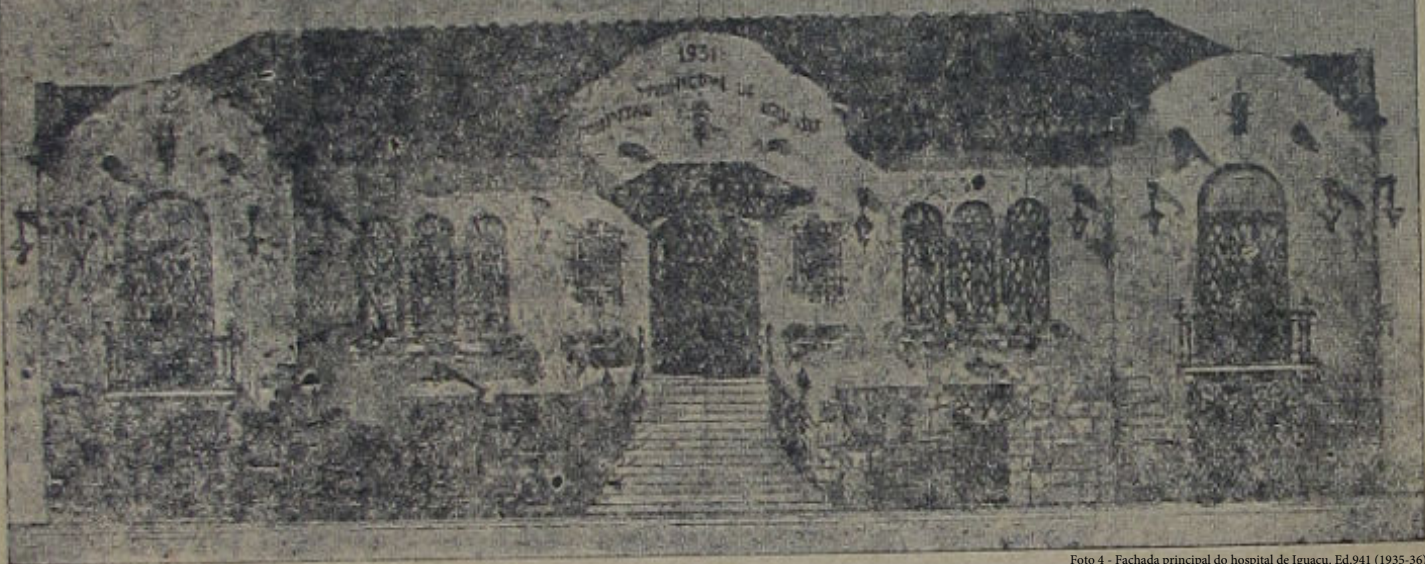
Fachada principal do hospital de Iguaçú. Ed.941 (1935-36)
